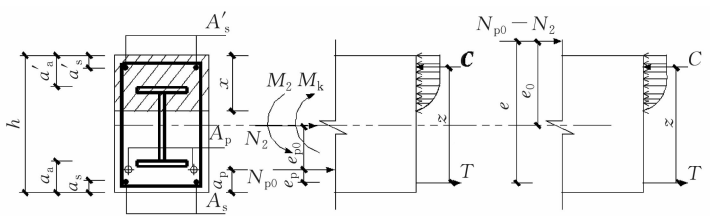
预应力型钢混凝土框架梁最大裂缝宽度计算简图
